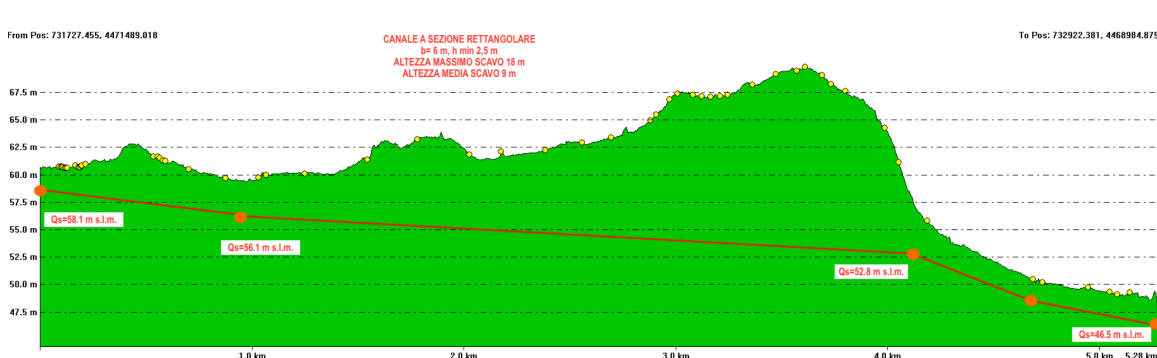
Profilo longitudinale di massima - Soluzione 1
